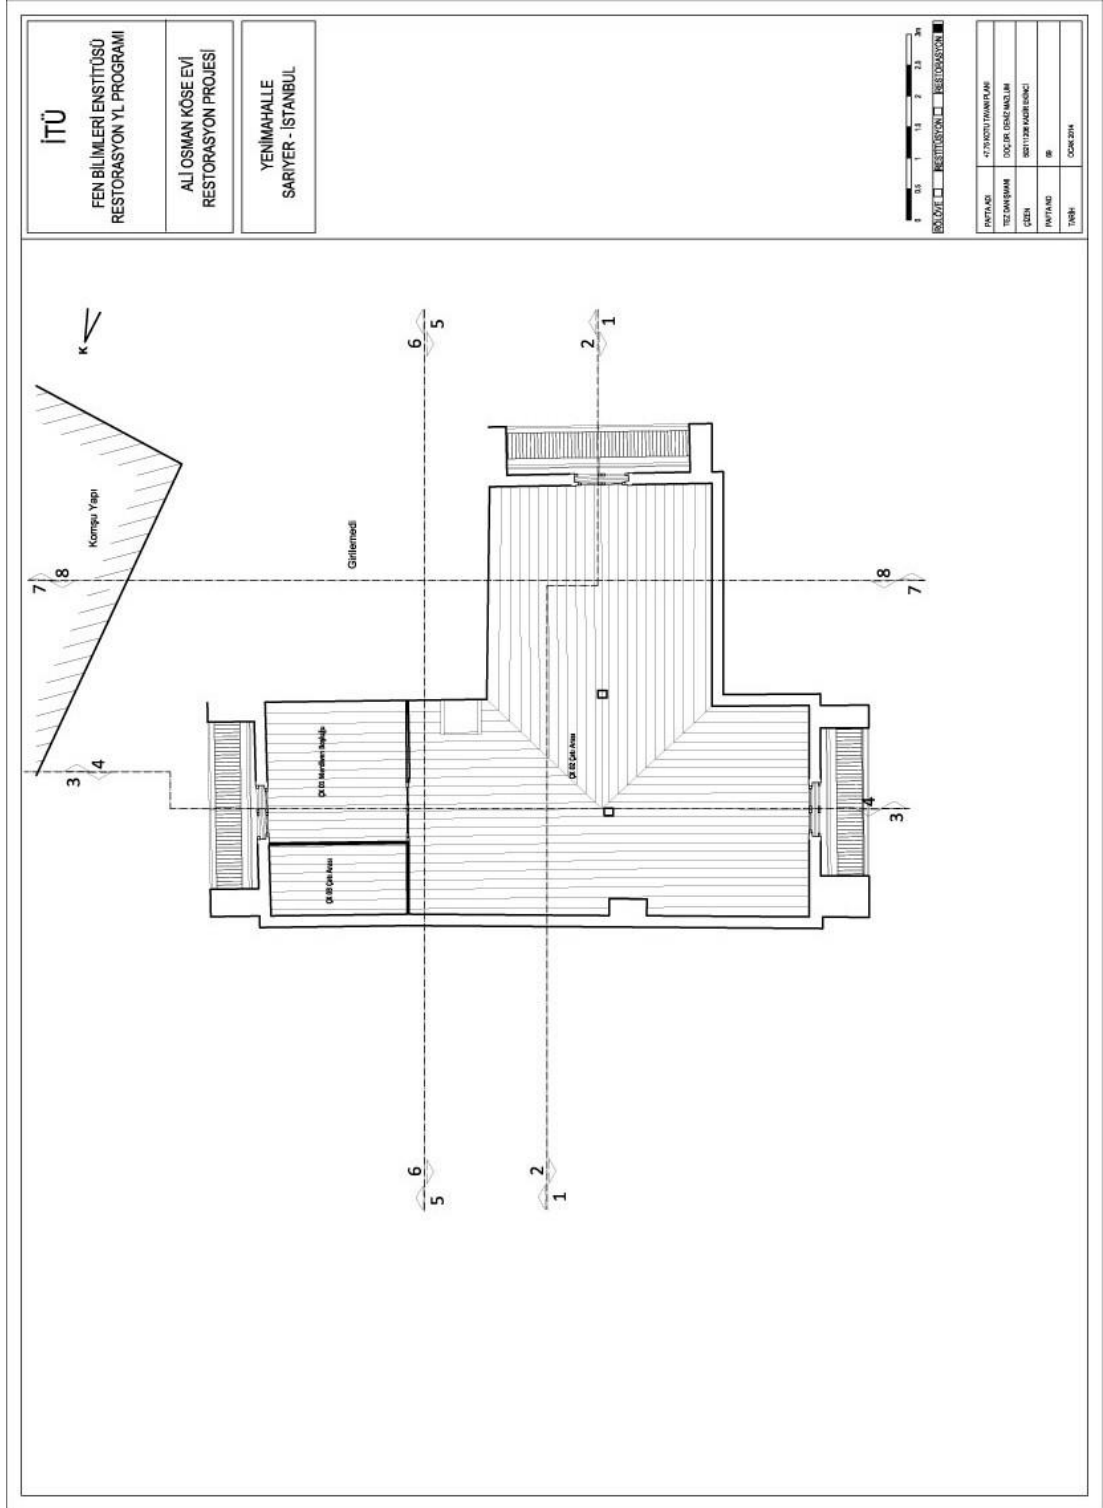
Restorasyon – +2.00 kotu tavan planı.
